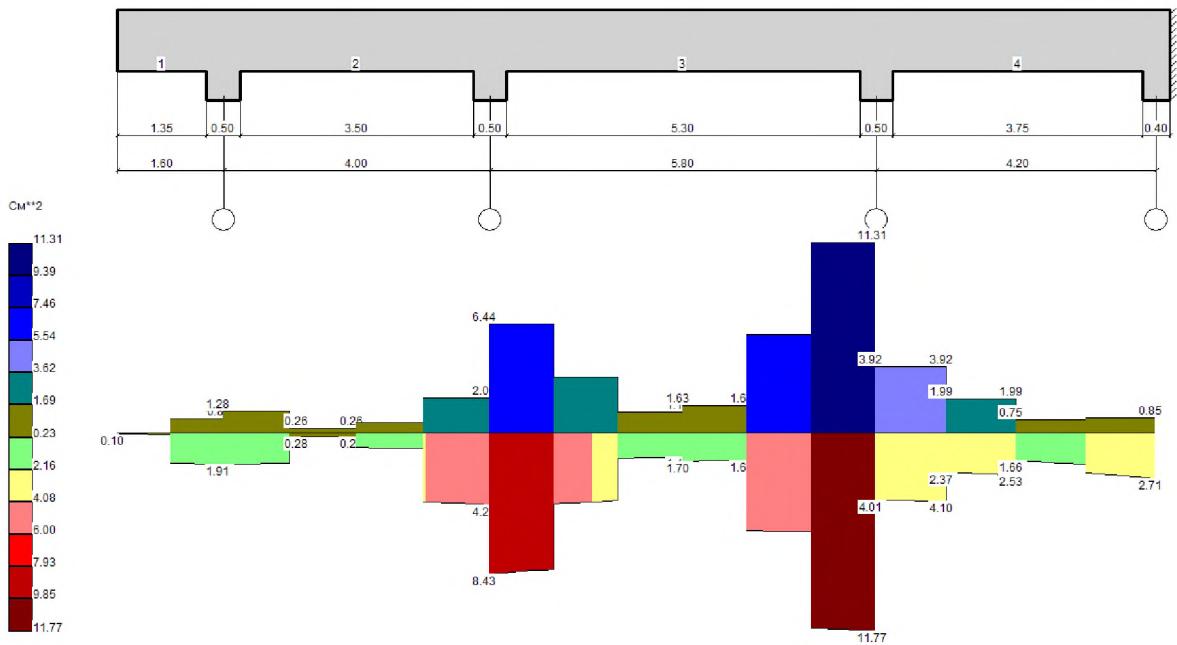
Балка № 3. Епюра поперечного армування
